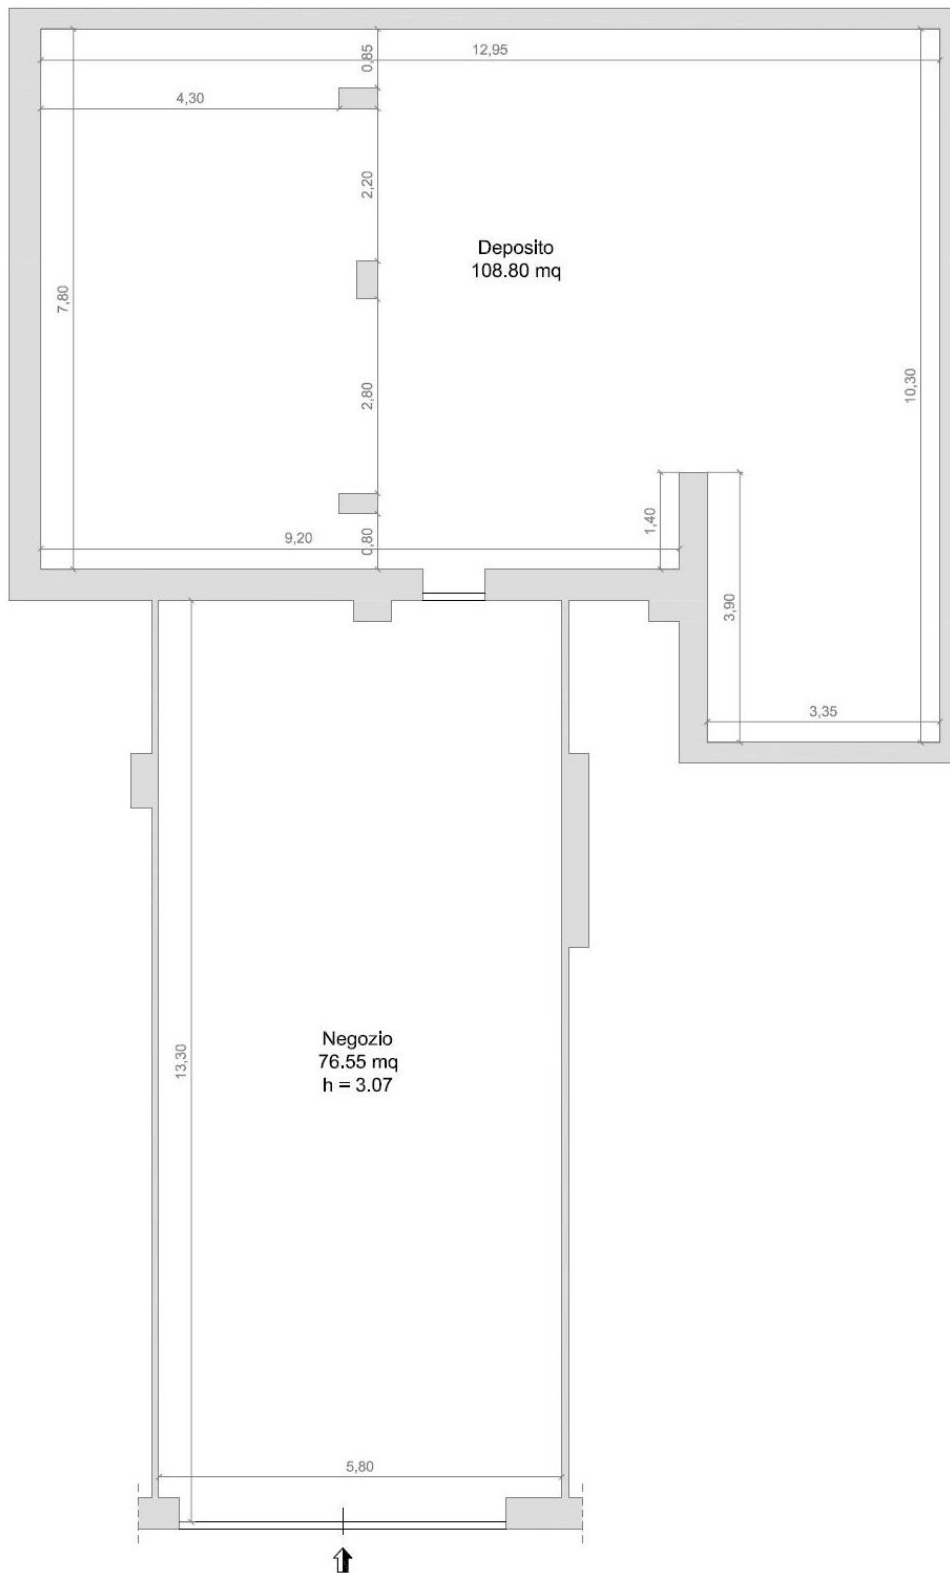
Planimetria Catastale Foglio 46, p.lla 1235, sub 14.
